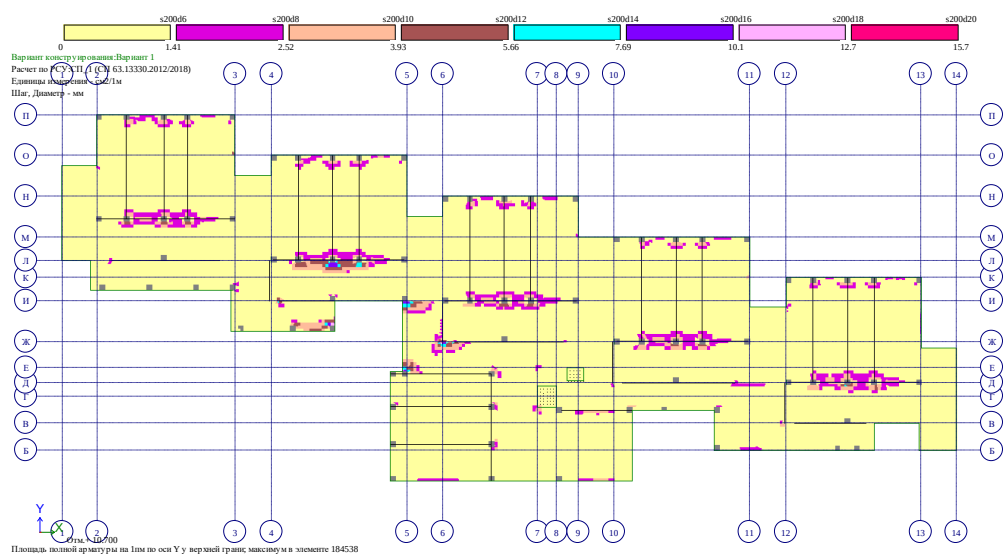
Схема армирования плиты перекрытия у верхней грани вдоль оси Y
